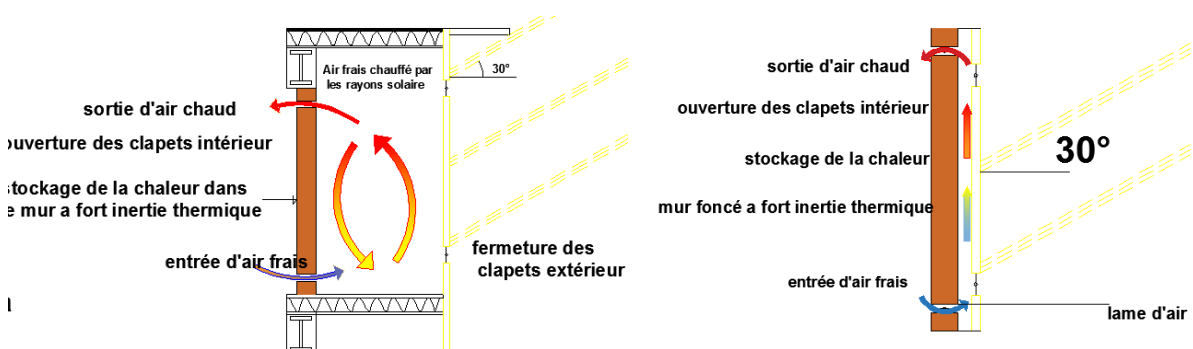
Zoom sur Serre bioclimatique et mur trombe Coupe AA
